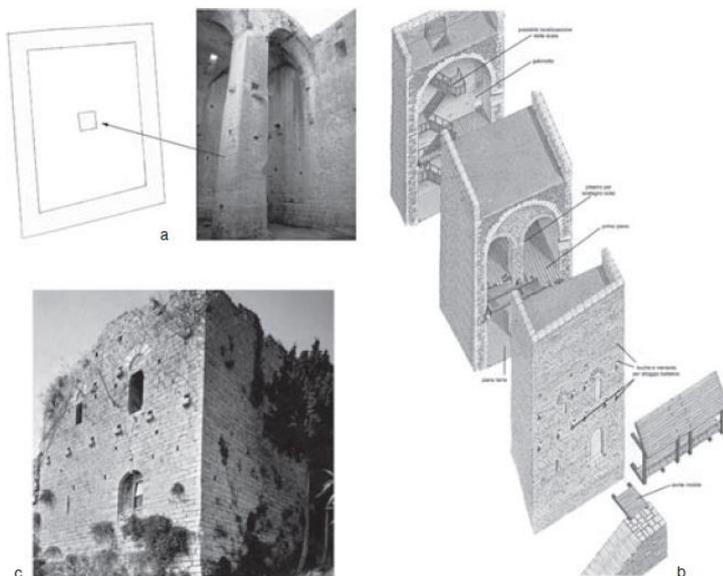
Planimetria; ricostruzione grafica; lato S.
